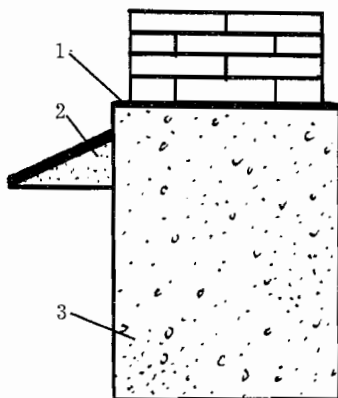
Монолитный бетонный фундамент: 1 — горизонтальная гидроизоляция; 2 — отмостка; 3 — монолитный железобетон.
